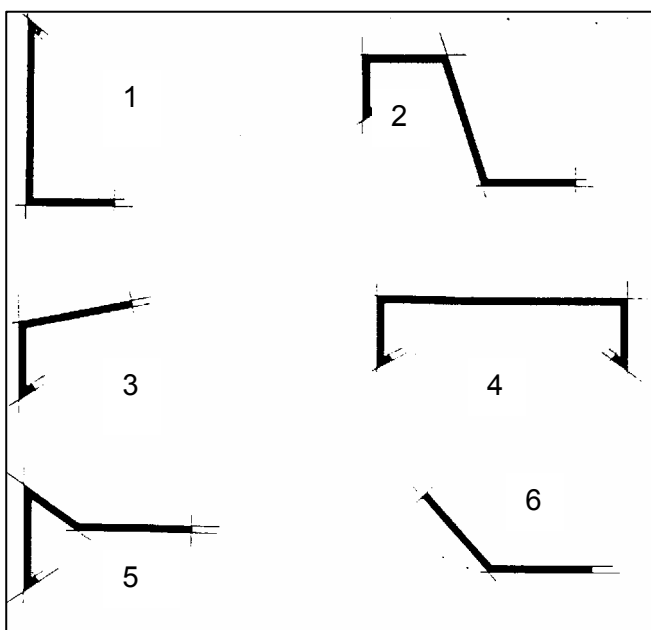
Примеры изготовления профилей из металлического листа “Carisma CB” для:
